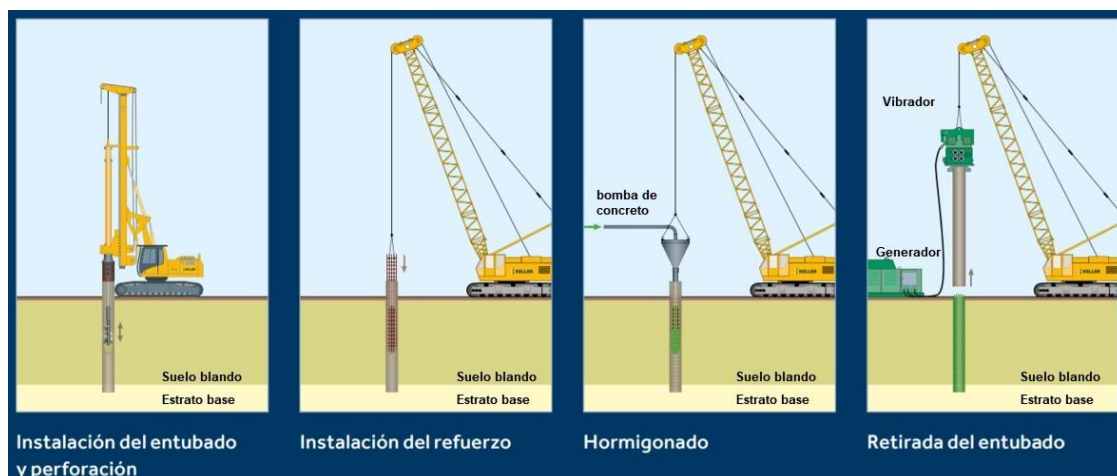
Proceso constructivo de pilotes colados in-situ.
